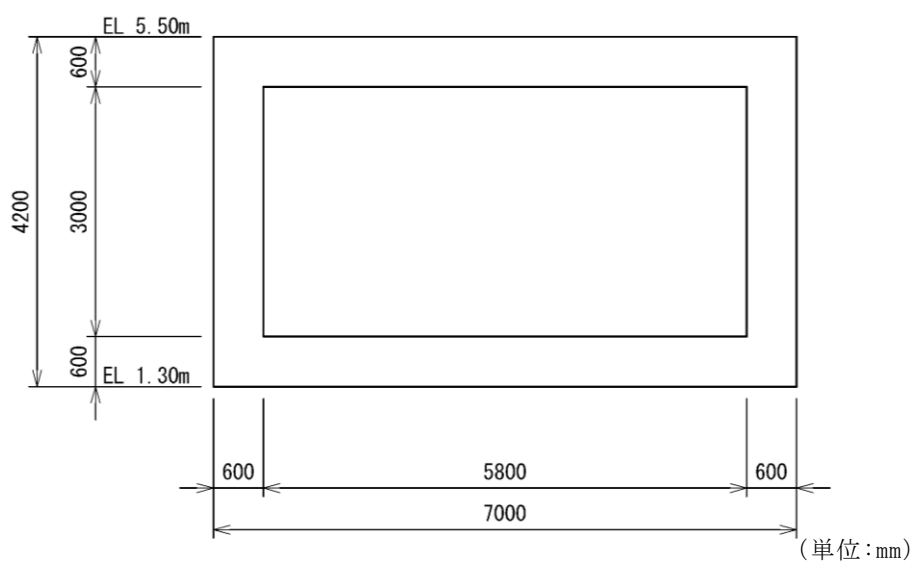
屋外配管ダクト (タービン建物～放水槽) 断面図 (A-A 断面)
